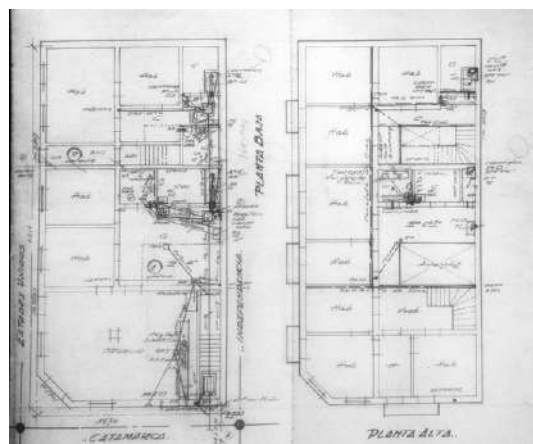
Planta original del actual edificio del "Hotel Jardín".
